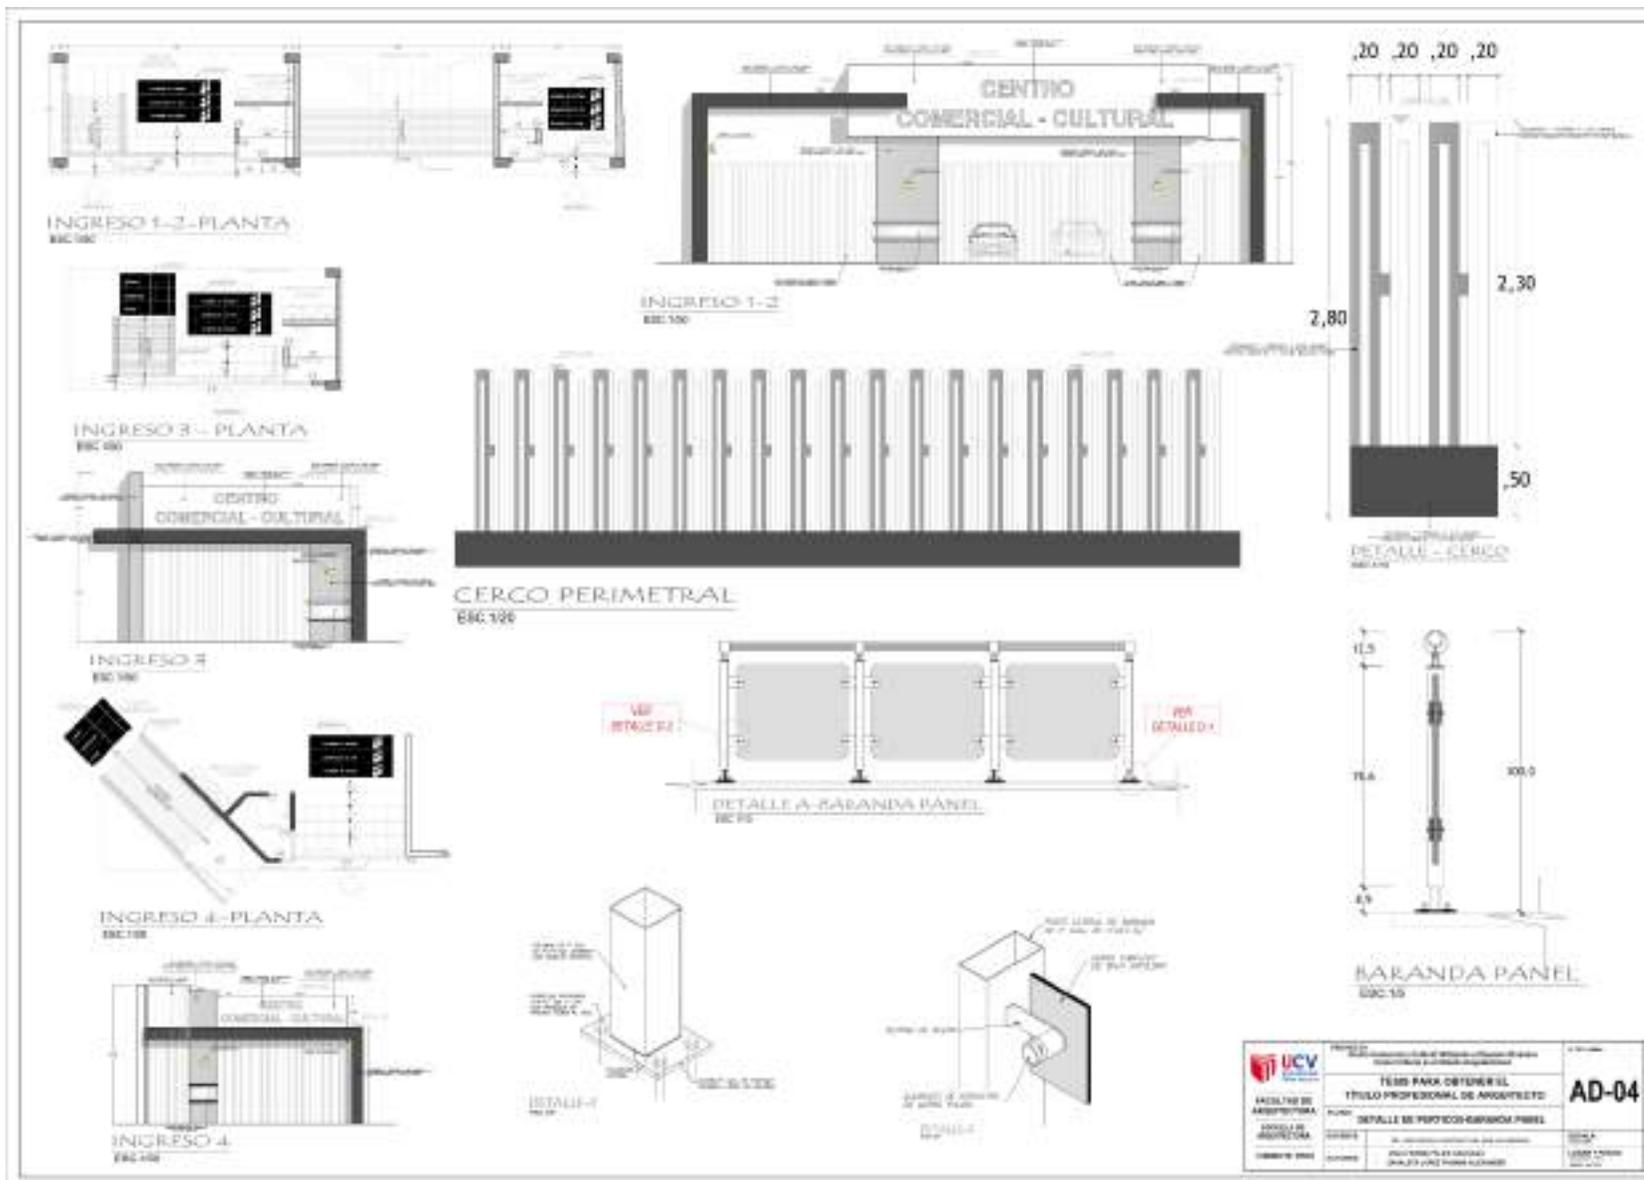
Detalle Constructivo Pórticos, Cerco Perimétrico, Barranda y Paneles
